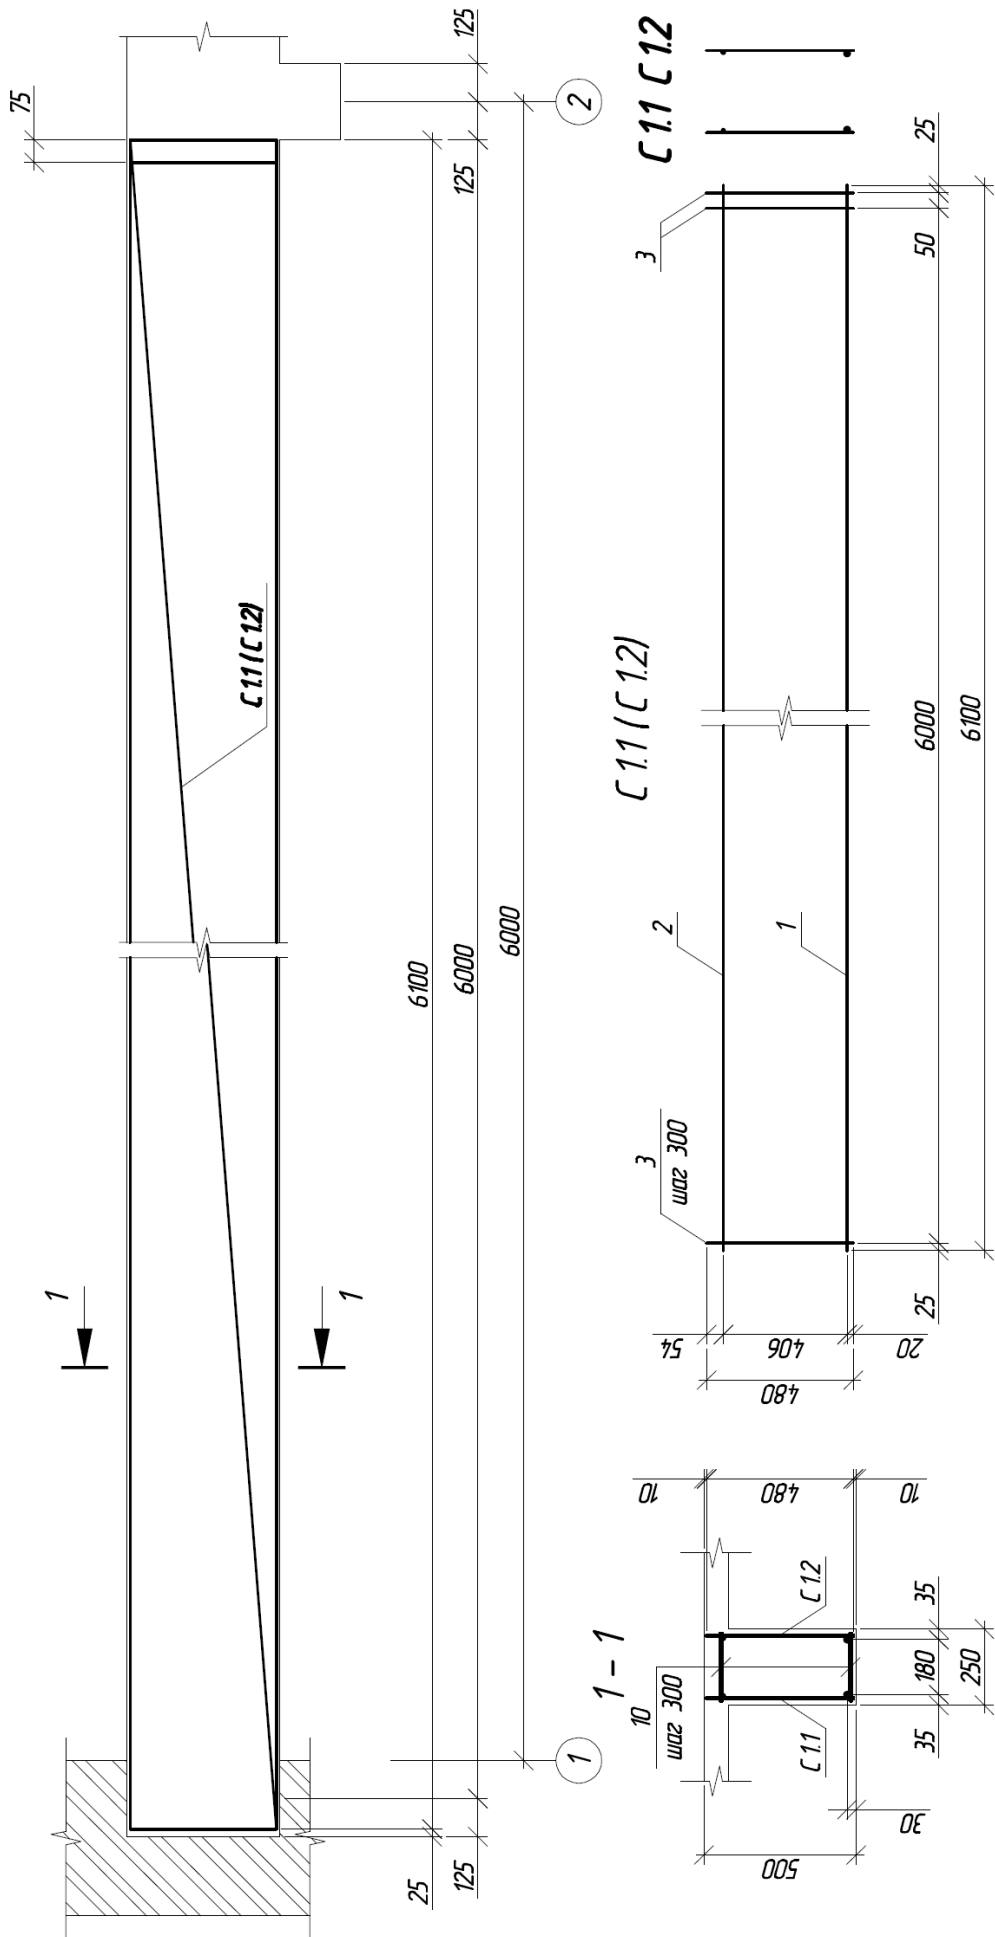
Схема армирования крайнего пролета второстепенной балки
